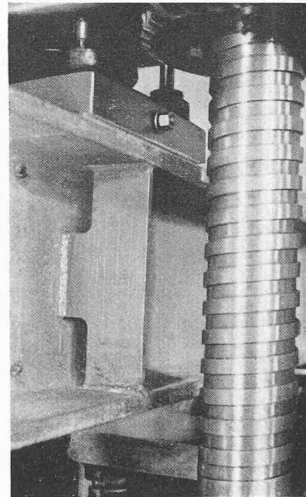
Raidissement en forme de T couché intercalé entre les ailes d'un profil en double T. Poutre d'essai sous l'une des presses du Laboratoire d'essai des matériaux de l'École d'ingénieurs de l'Université de Lausanne.
